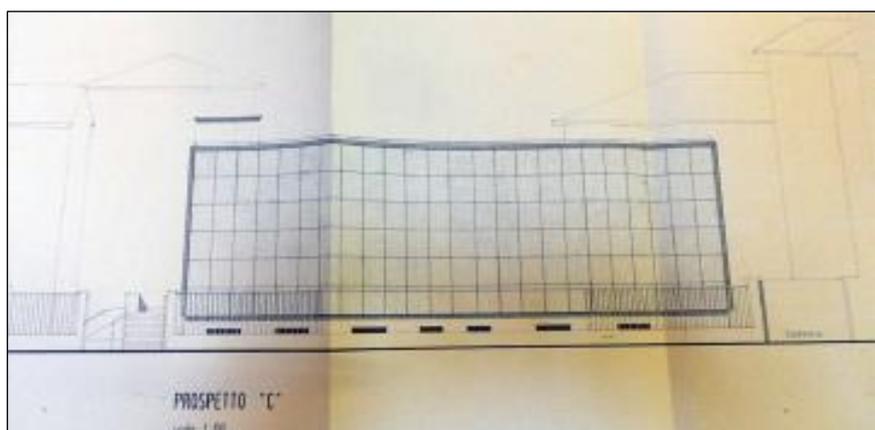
Intervento per la realizzazione del nuovo poliambulatorio (1991) – Prospetto su Via Otto Colonne
